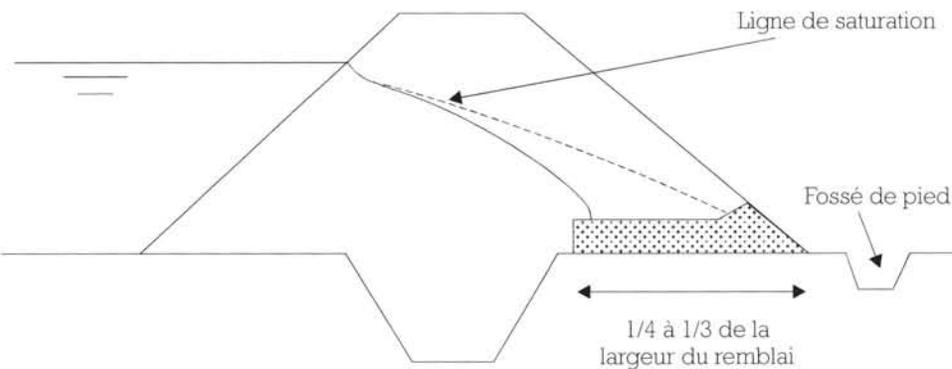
Tapis drainant aval - rabattement de la ligne de saturation.
